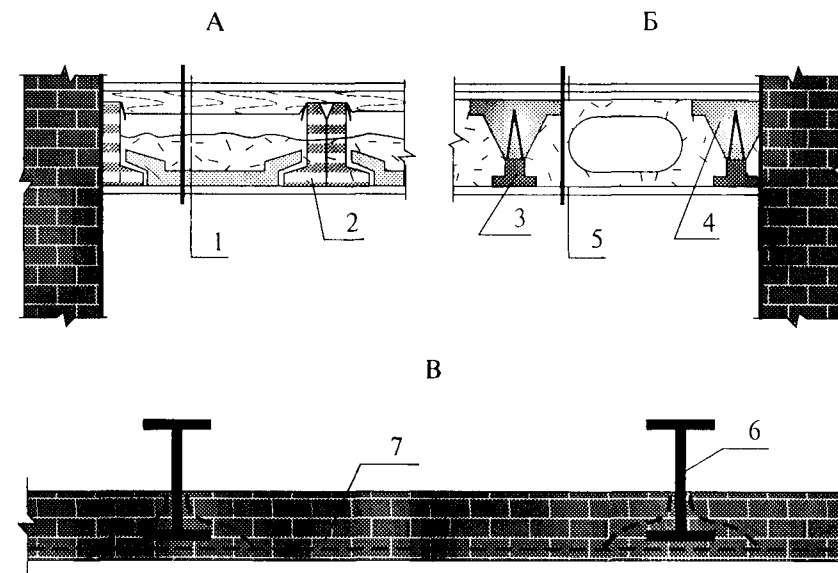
Сборные, сборно-монолитные и монолитные перекрытия
